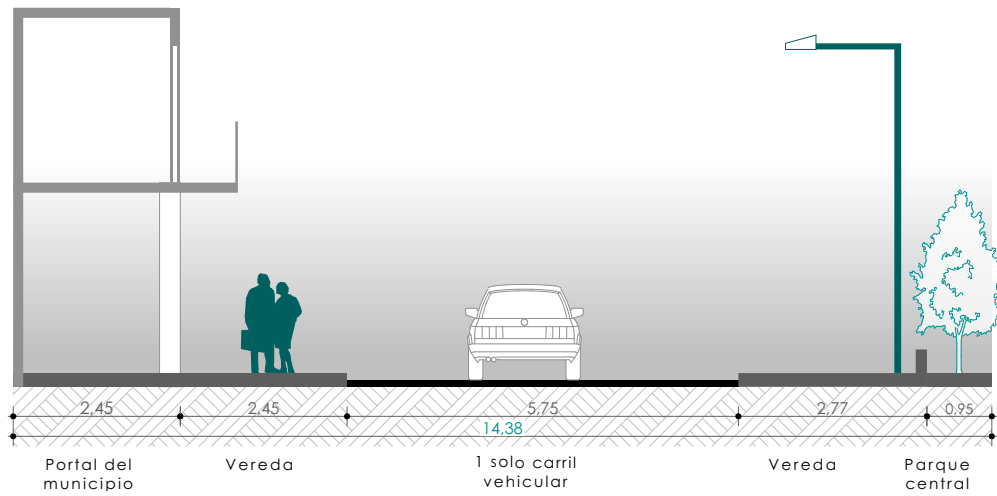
Sección S_03 calle Sucre. Imagen: propia
